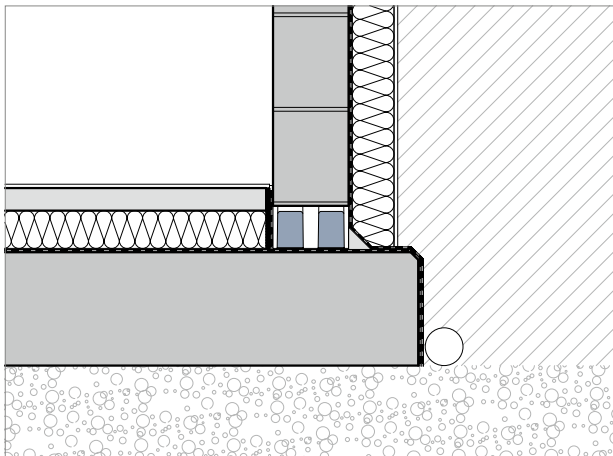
Schöck Sconnex® Typ M Außenwand auf Gründungsbauteil
